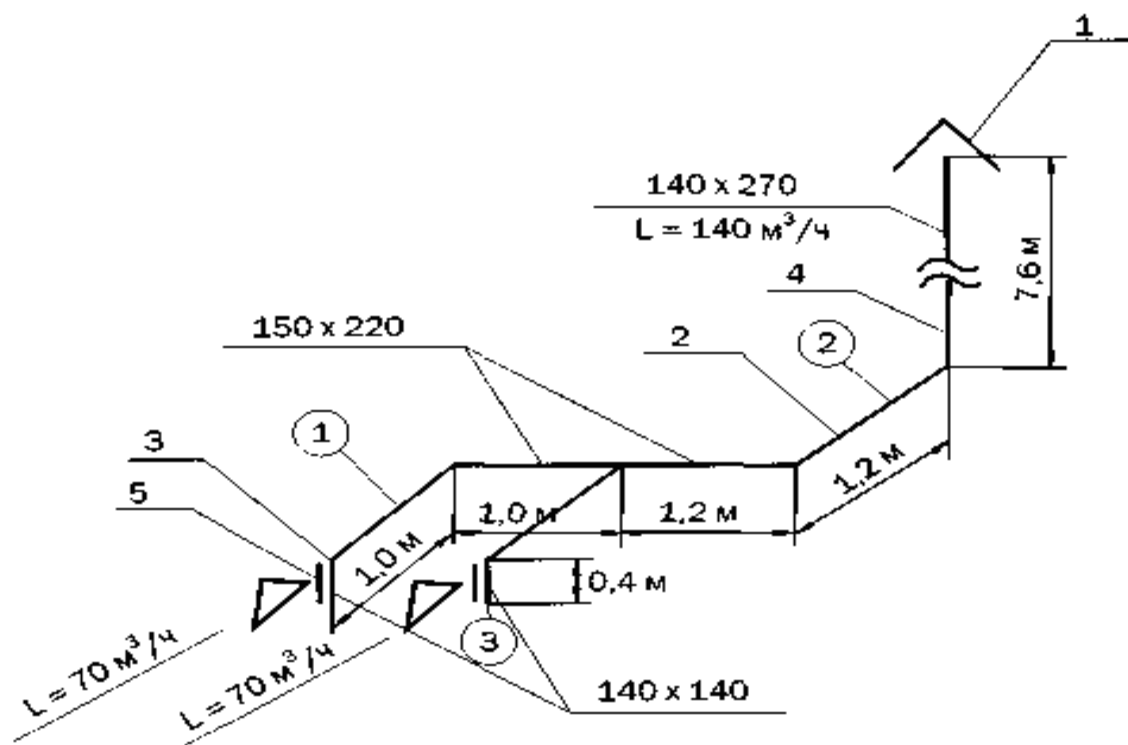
Розрахункова аксонометрична схема: 1 - витяжний парасоль; 2 - утеплений шлакогіпсовий короб; 3 - канал; 4 — шахта; 5 — решітка.
